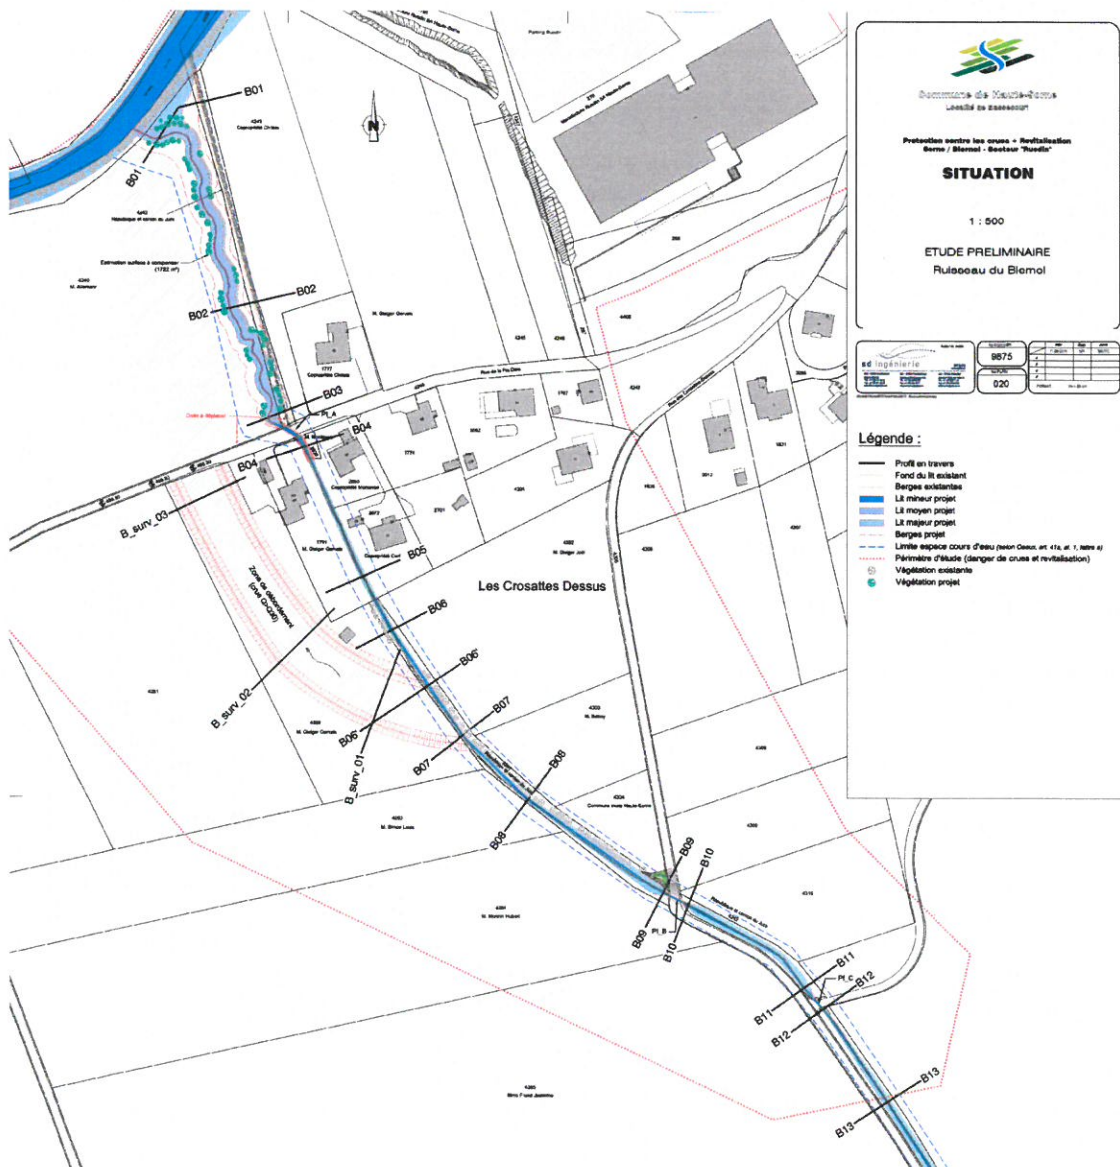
extrait du plan de situation du Biernol au 1 : 500
